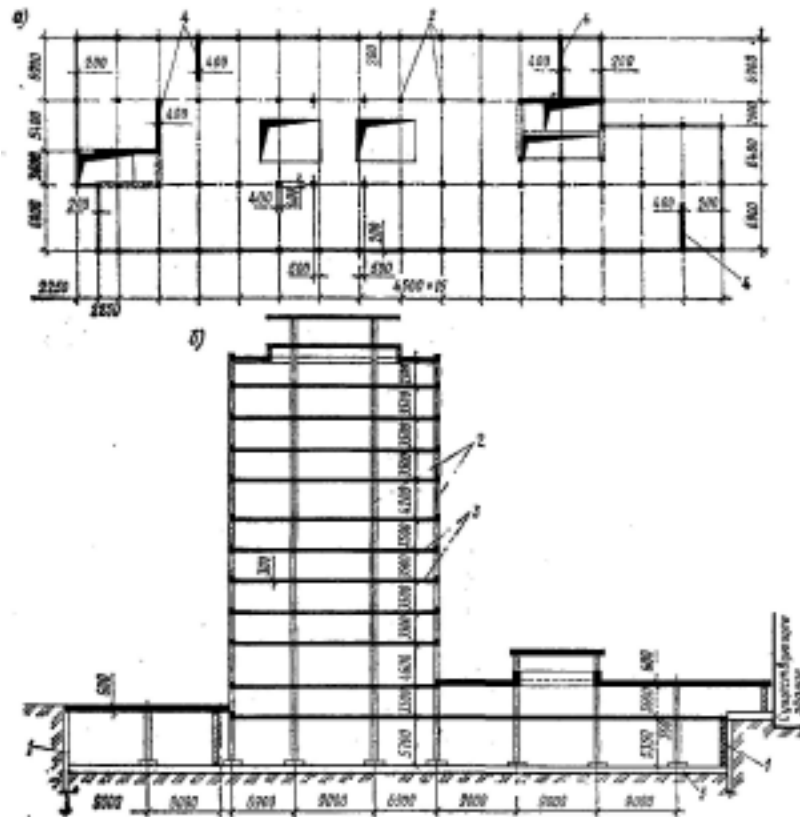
Конструктивная схема каркасного здания из монолитного железобетона:
